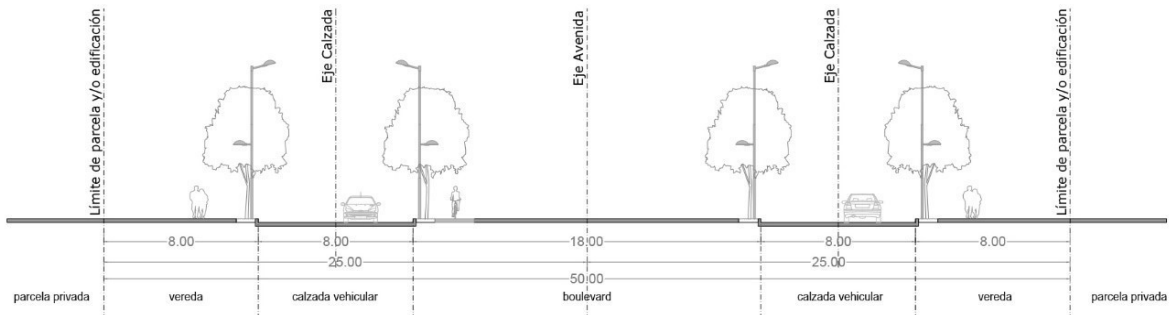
Sección transversal de Vías Avenidas Tipo 2.
